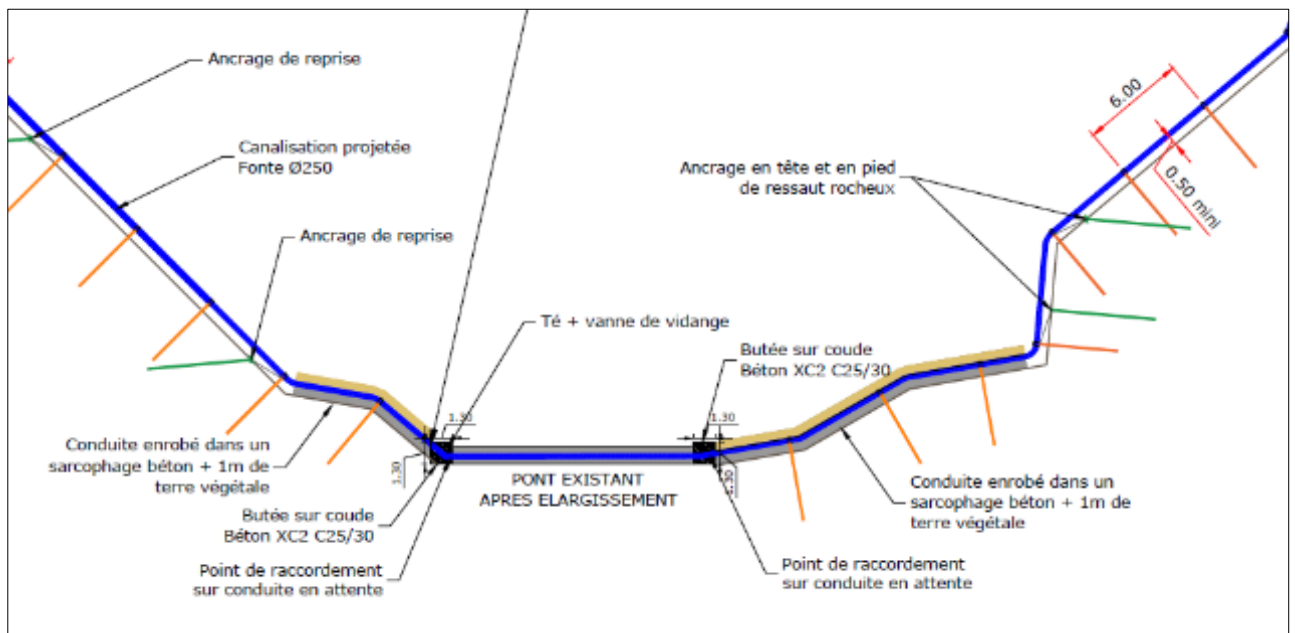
Extrait du plan de principe de passage de la ravine Montplaisir DCE HYDRETTUES 01/2021
